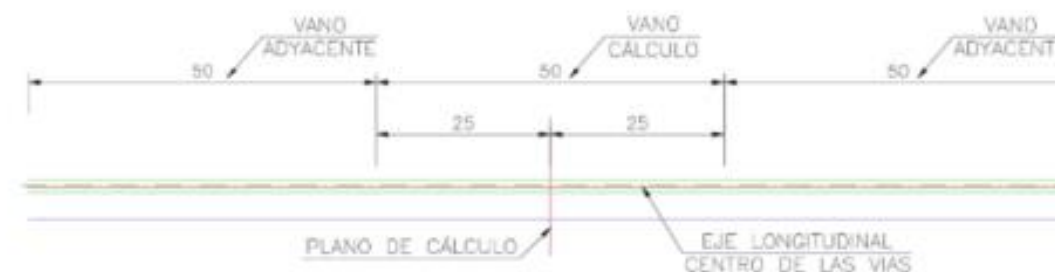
Planta de los vanos modelados y localización del plano de cálculo (cotas en metros).
